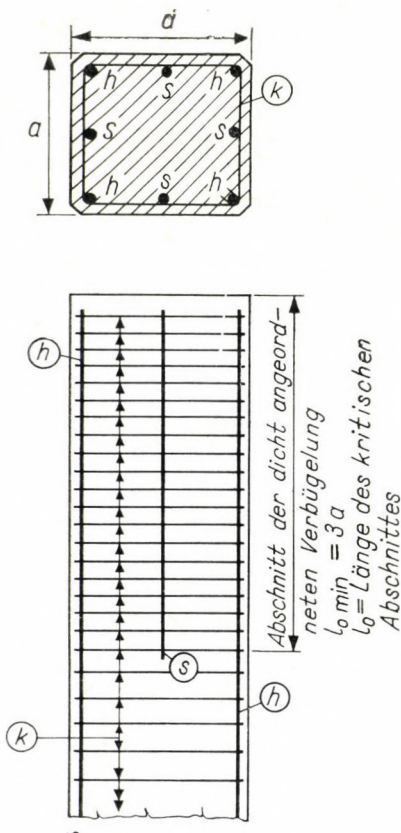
Anordnung der Kopfbewehrung des Stahlbetonpfahls
